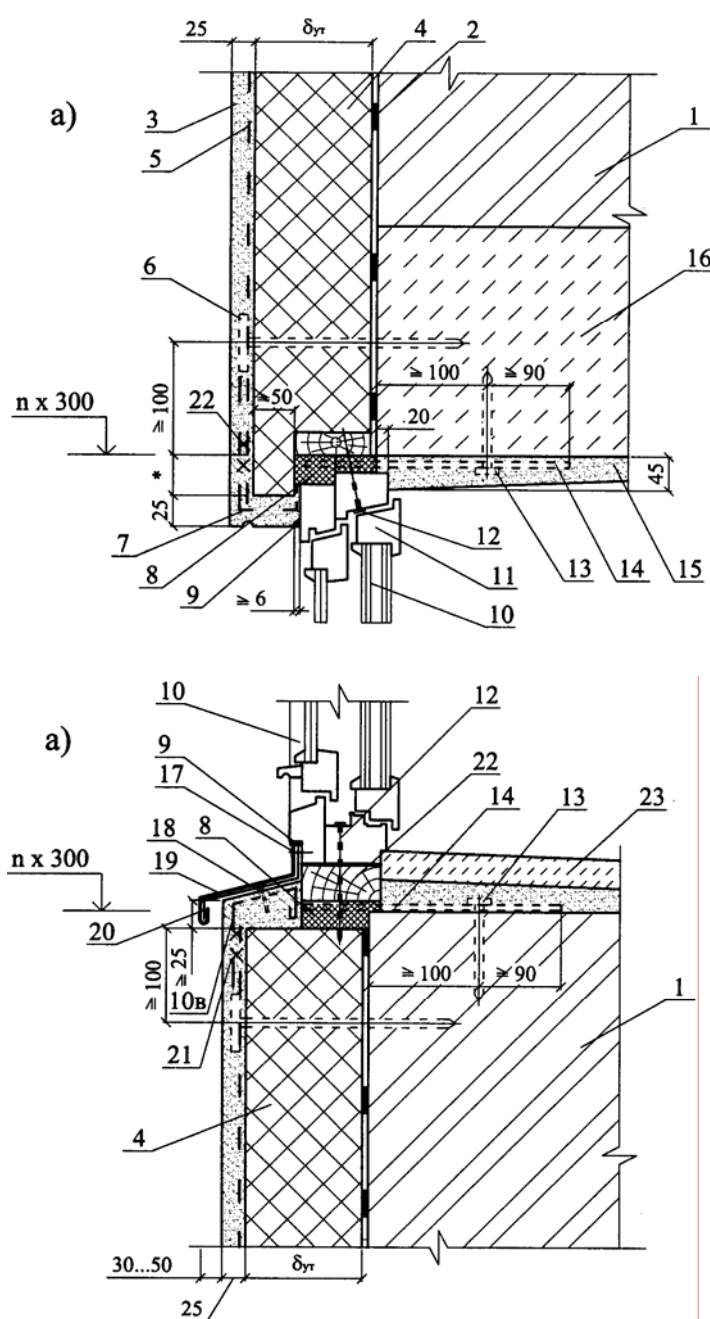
Вертикальный разрез примыкания окна к стене: верх (а) и низ (б) окна
